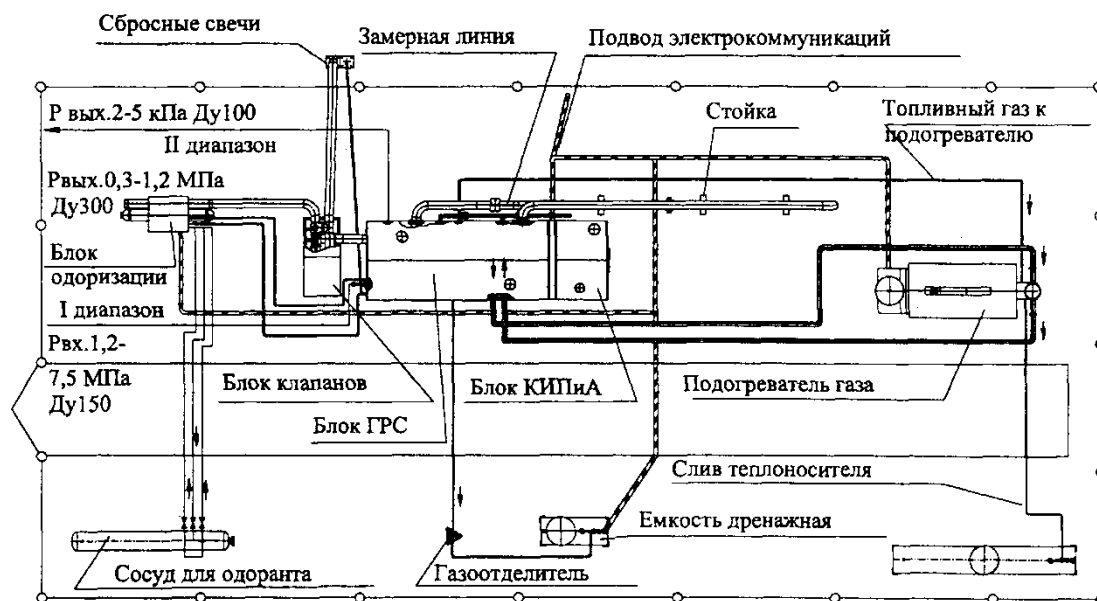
Схема размещения блоков станции "САРАТОВ-50" на площадке
